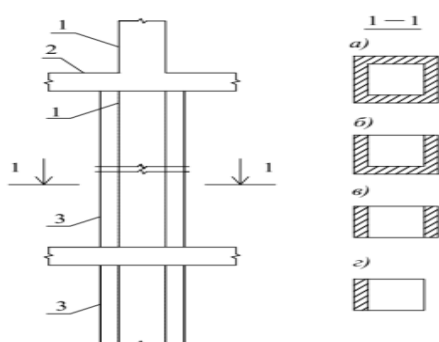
Конструктивные решения усиления столбов опоры увеличением площади поперечного сечения: а – железобетонная обойма; б – наращивание сечения; в – двухсторонне наращивание; г – односторонне наращивание; 1 – опора; 2 – элемент пролетного строения; 3 – элемент усиления
